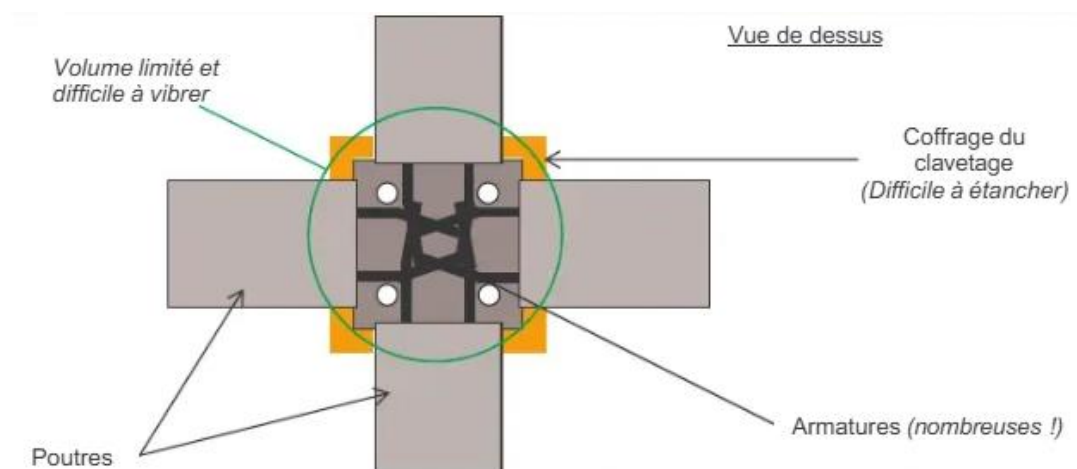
12: schéma de principe du clavetage au niveau d'un nœud poutre-poteau [3]
